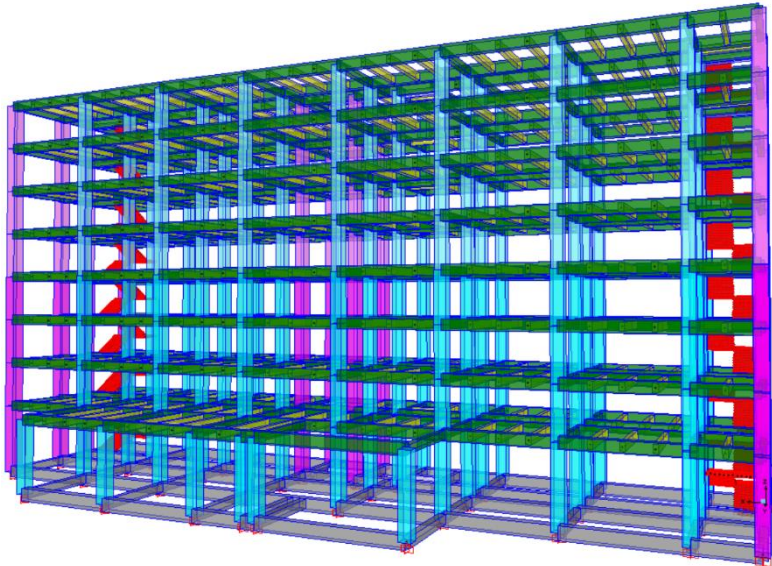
Permodelan Denah Hotel Pesonna Surabaya
